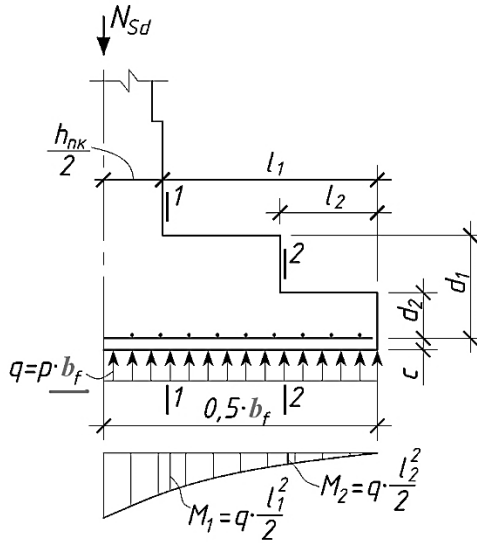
Расчетная схема фундамента при определении площади рабочей арматуры нижней ступени для плитной части фундамента
